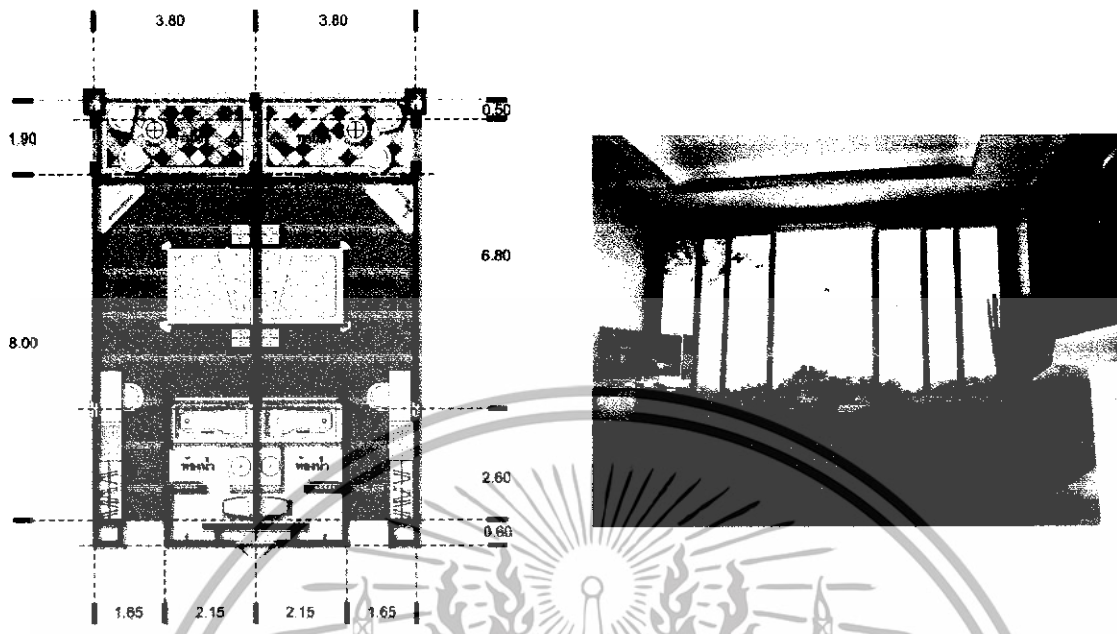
แสดงแปลนที่ชั้น 4
